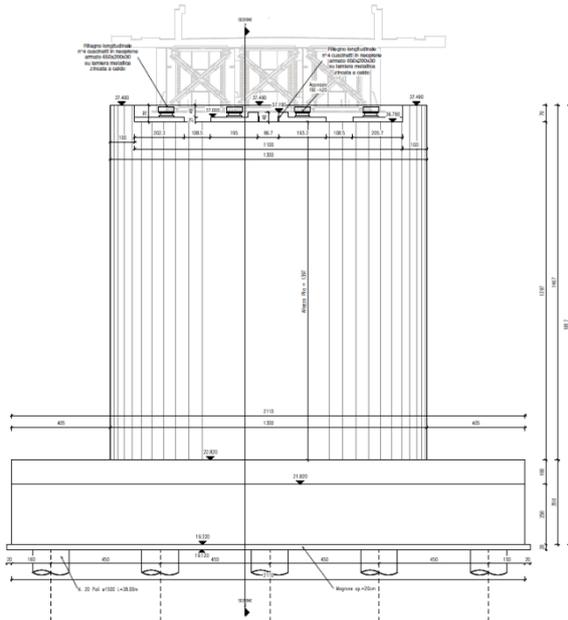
Viadotto Ali: sezione trasversale e prospetto binario pari
